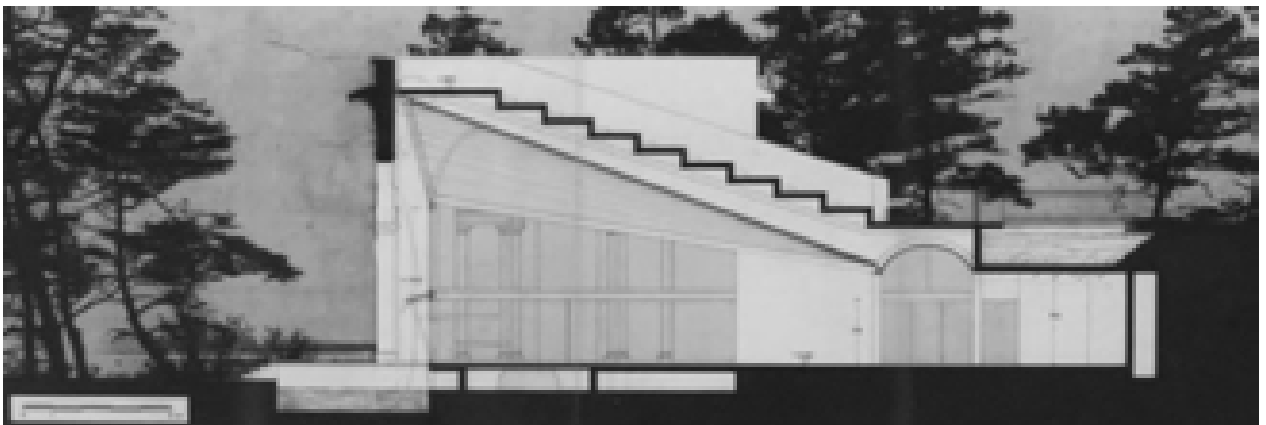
Sezione AA, stato futuro - Progetto del 15/07/1985, agg. del 15/01/1987 (AABS-147)
